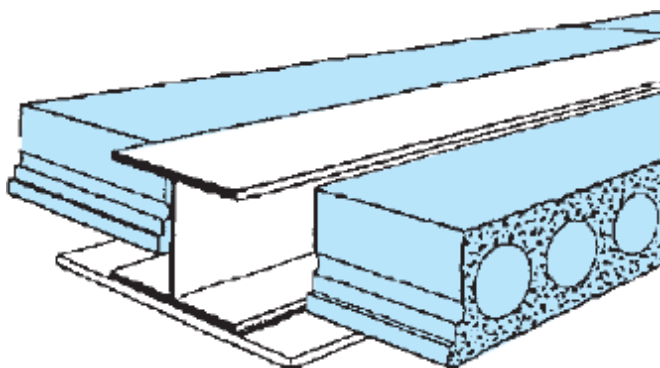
dalle alvéolée précontrainte intégrée à une poutre en acier.
